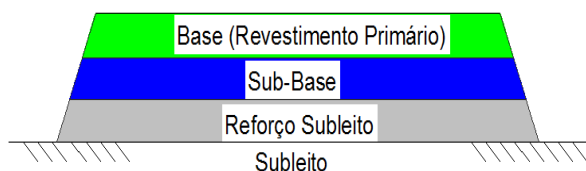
Camadas de um Pavimento com Revestimento Primário.
